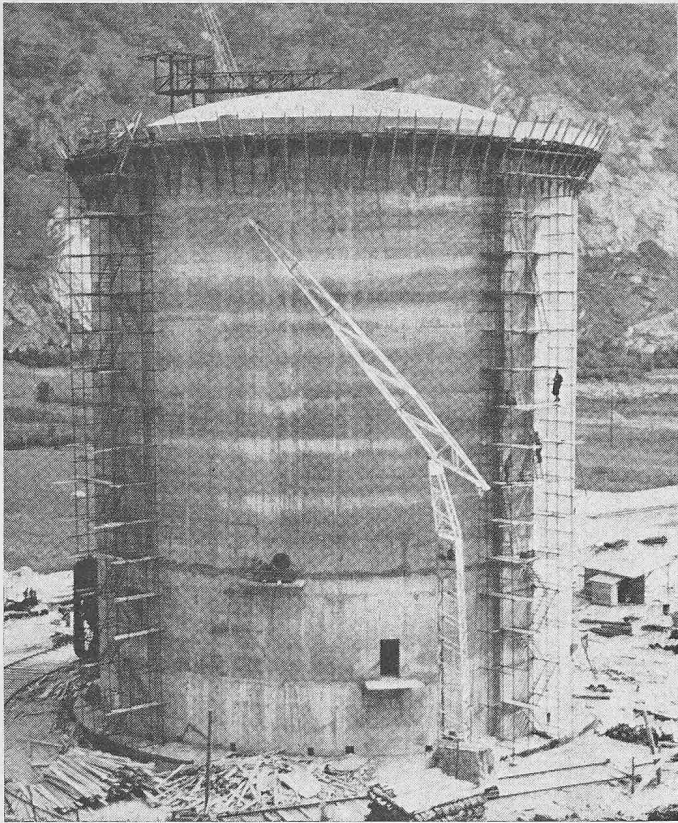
Silo samt Kuppeldach betoniert. Vor den 4 Lisenen stehen die Rohrgerüste als Arbeitsbühnen für das Spannen der Vorspannbewehrung
